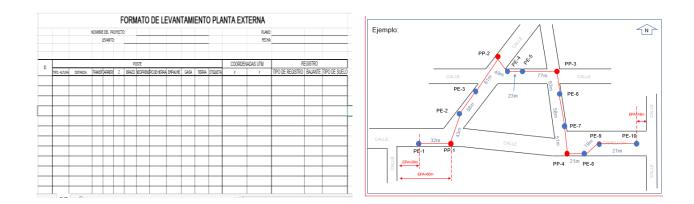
FIGURA DE UN FORMATO DE LEVANTAMIENTO Y PLANO DE APOYO Fuente: Elaboración propia
